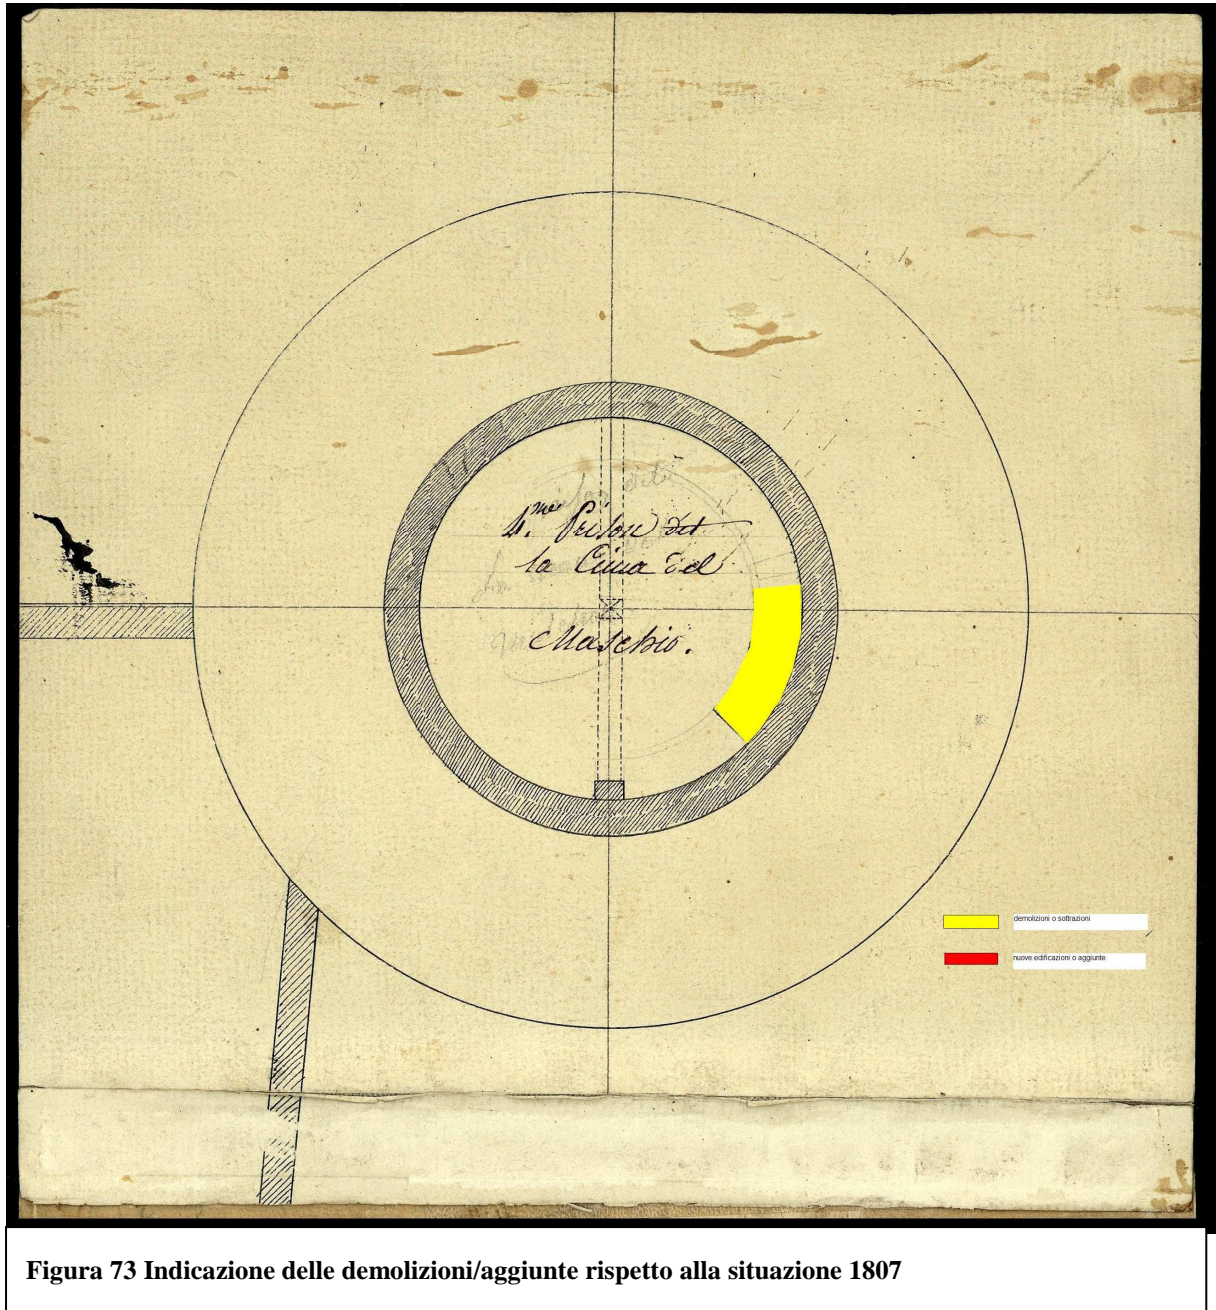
Indicazione delle demolizioni/aggiunte rispetto alla situazione 1807
